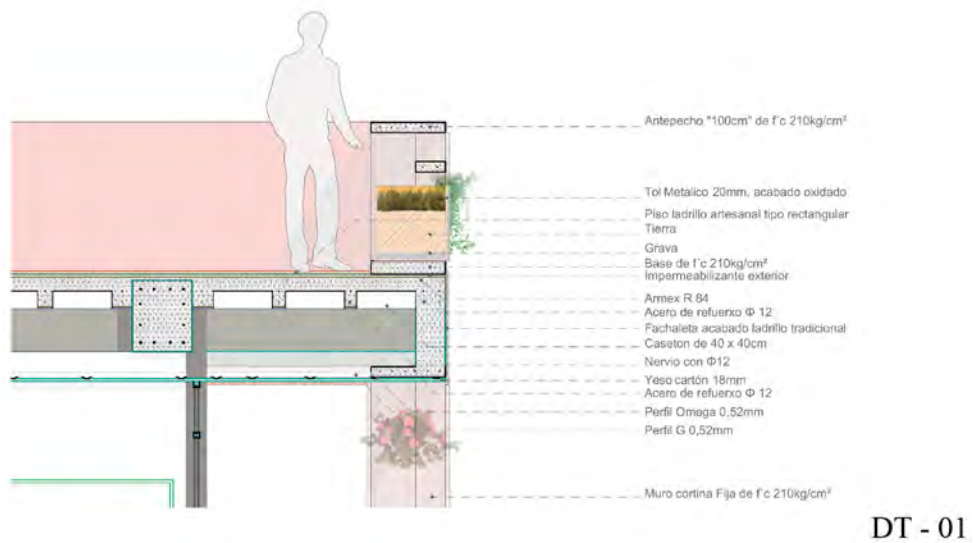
DT – 01 Sección constructiva - Remate de fachadas
